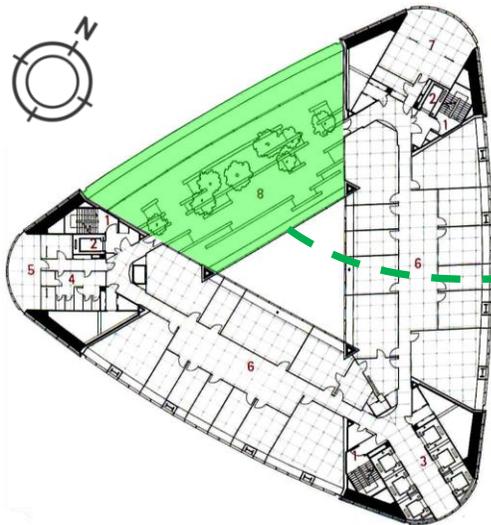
Planta baixa – Jardins voltados para o noroeste. Fonte: Davies & Lambot, 1997. Editado pelo Autor, 2016.
